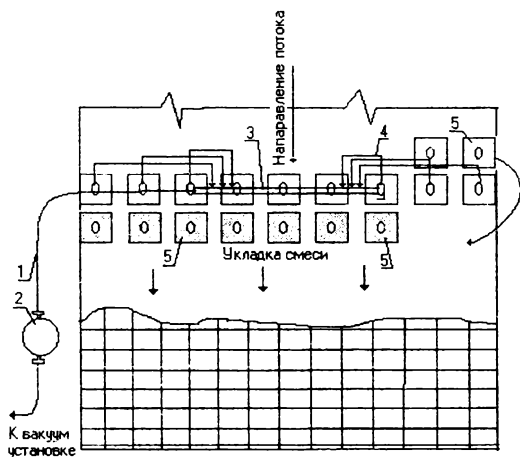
Схема вакуумирования железобетонной плиты.
